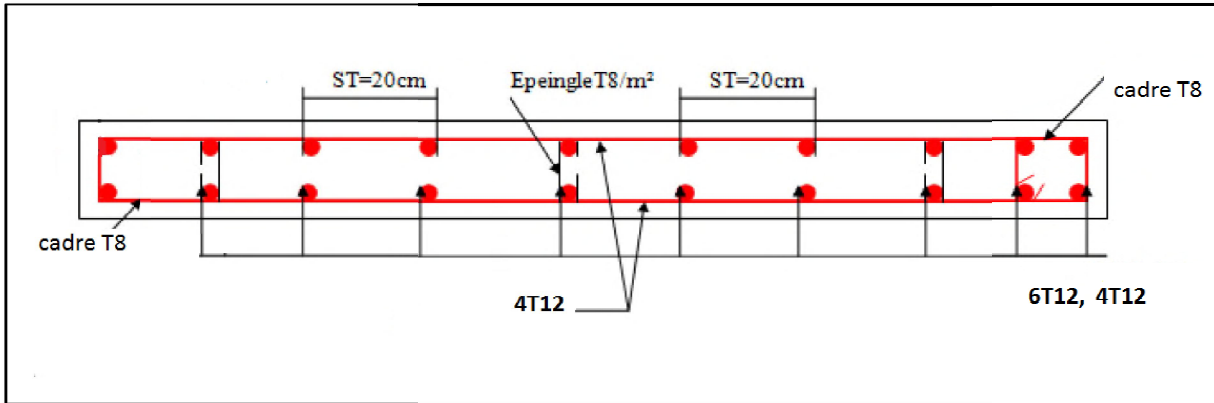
Schéma de ferrailage des dalles sur deux appuis.
